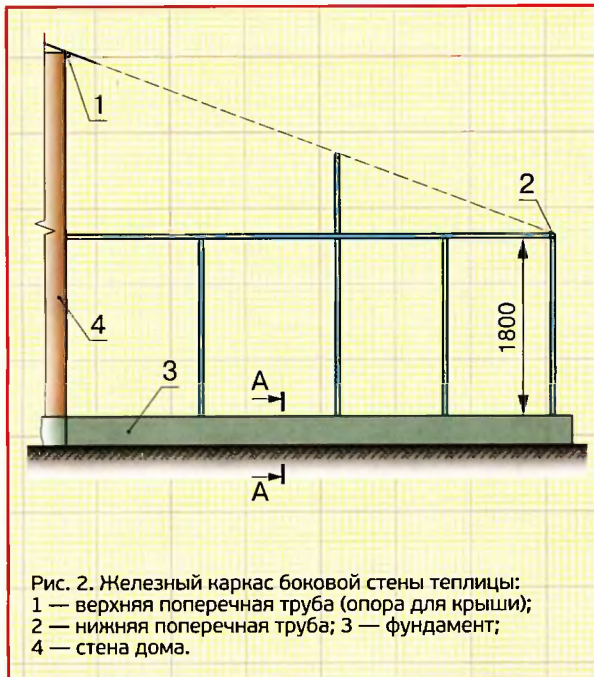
Железный каркас боковой стены теплицы: 1 — верхняя поперечная труба (опора для крыши); 2 — нижняя поперечная труба; 3 — фундамент; 4 — стена дома.
